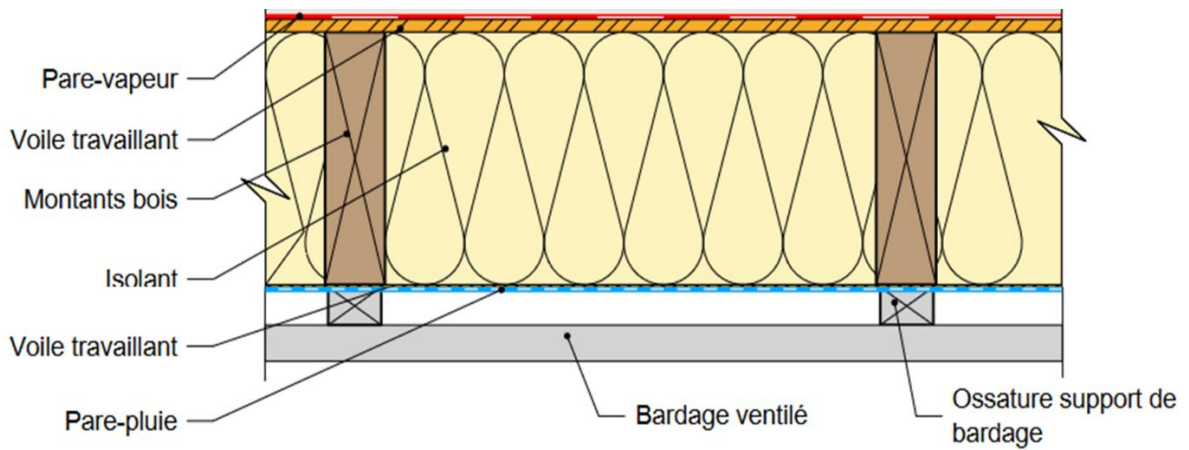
Paroi à ossature bois avec isolation entre montants avec système pare-pluie ou de protection à l'eau souple sur support discontinu (coupe horizontale)
